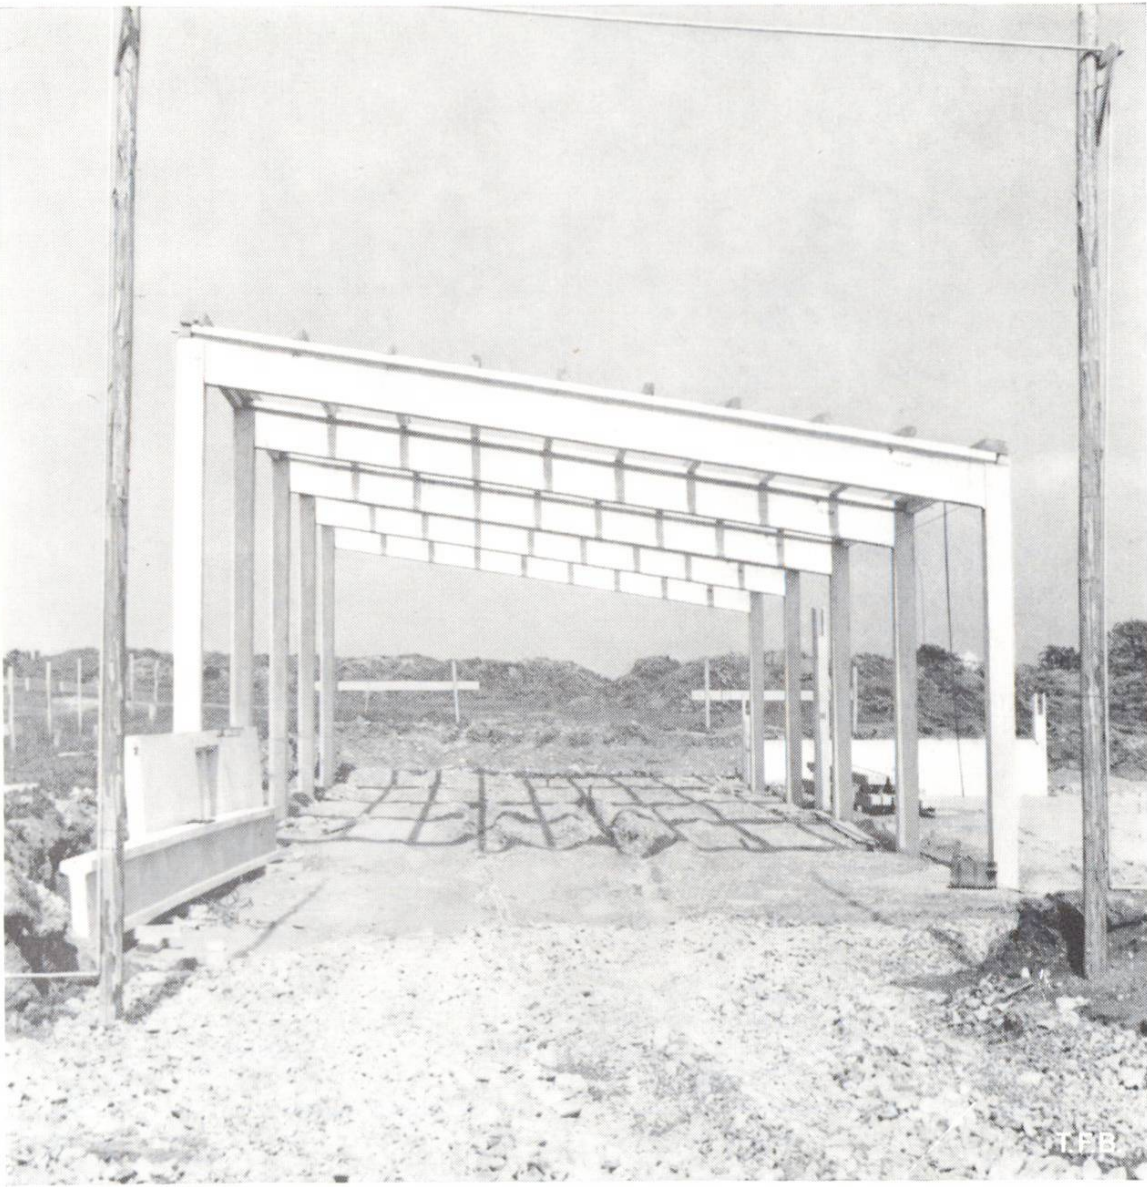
Kleine Halle als Schuppen und Futterküche mit einem geraden, 9 m messenden Dachbinder.
